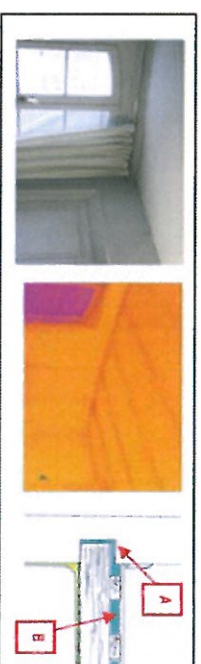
cas d'un plancher complet : poutres encastées, enfermées dans un caisson en plâtre (bâtiment 3) :
